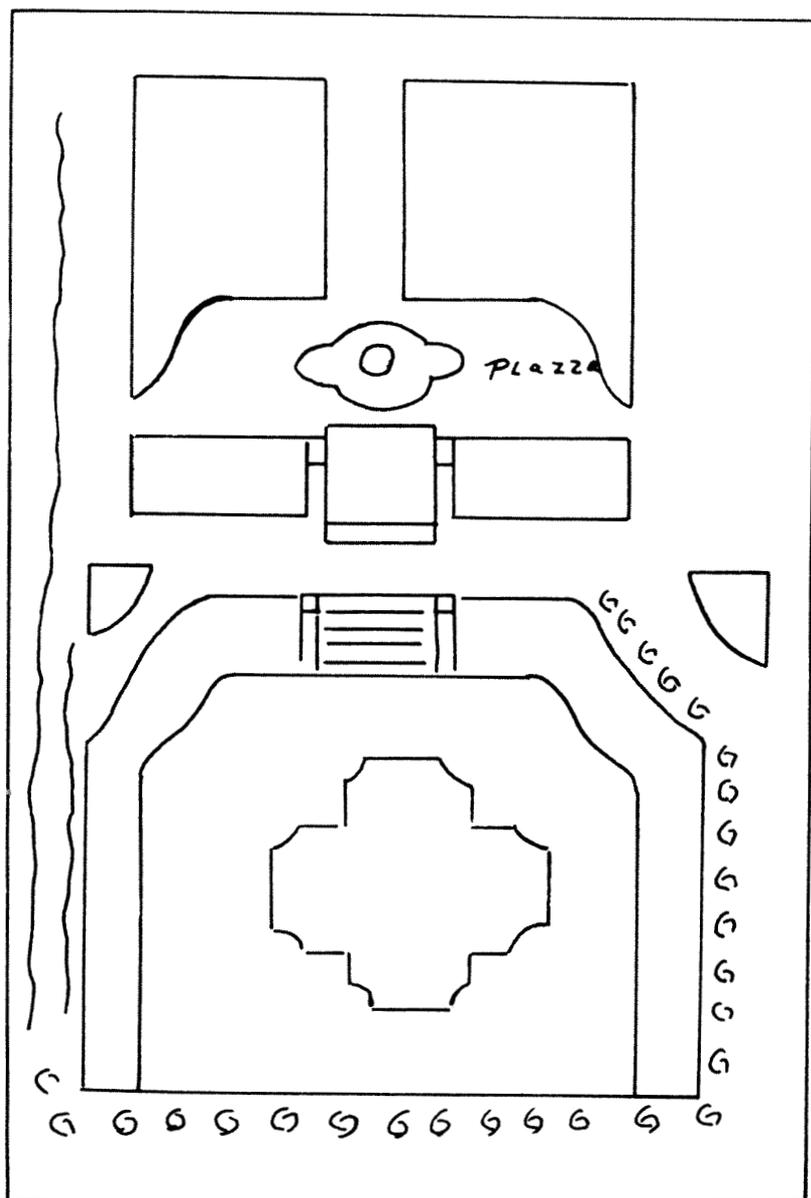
Plan de terrain trouvé dans les papiers de Brunet.
